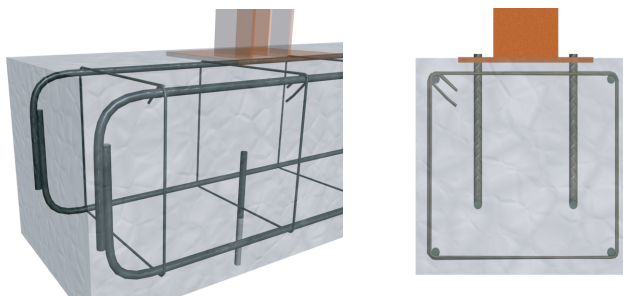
Cimentación. Izquierda: Esquema de la armadura y perno de anclaje. Derecha: Sección de la armadura.
